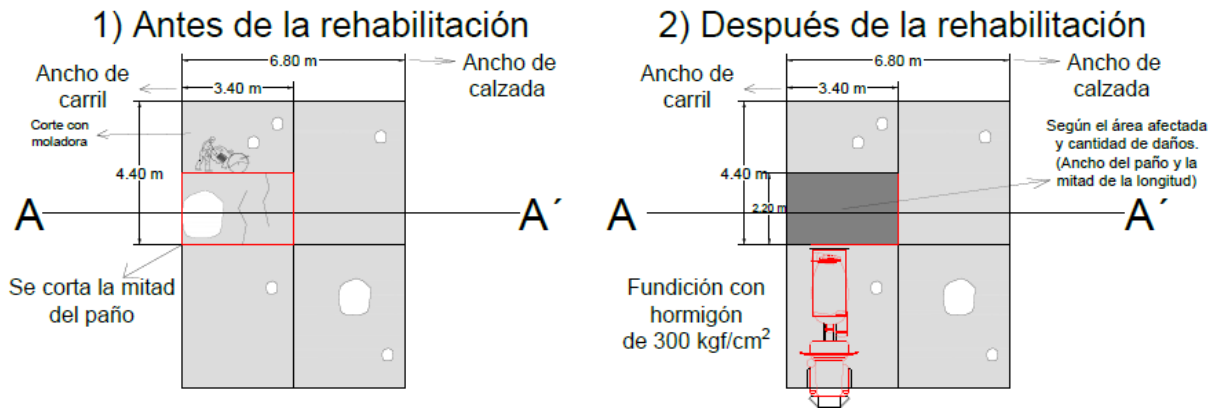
Sustitución Parcial de Losa, vista en planta.
